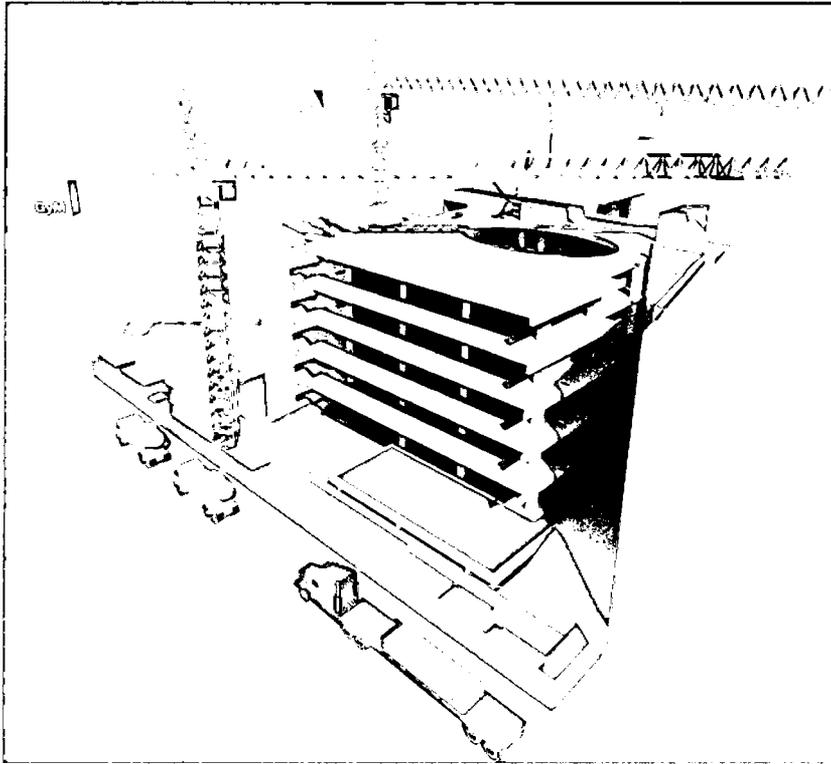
Layout 3D correspondiente al vaciado del último piso de la estructura
